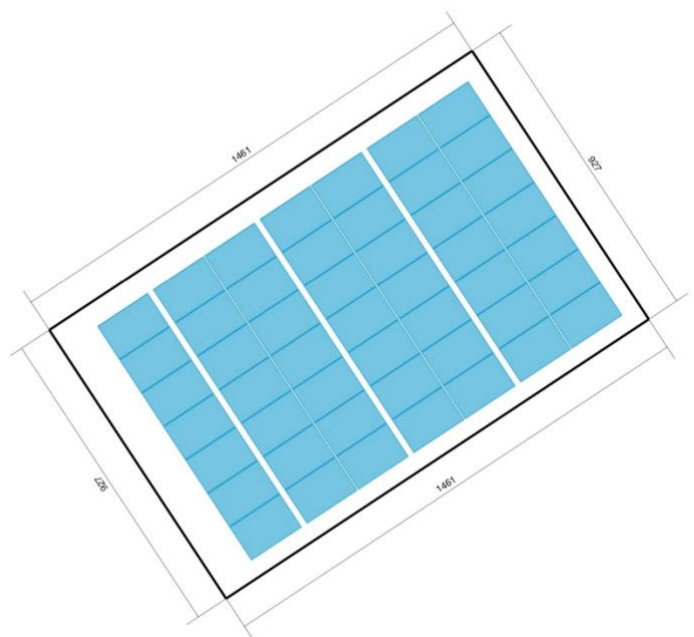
Herrenackerstrasse 29, Belegungsplan, Dachfläche 2
